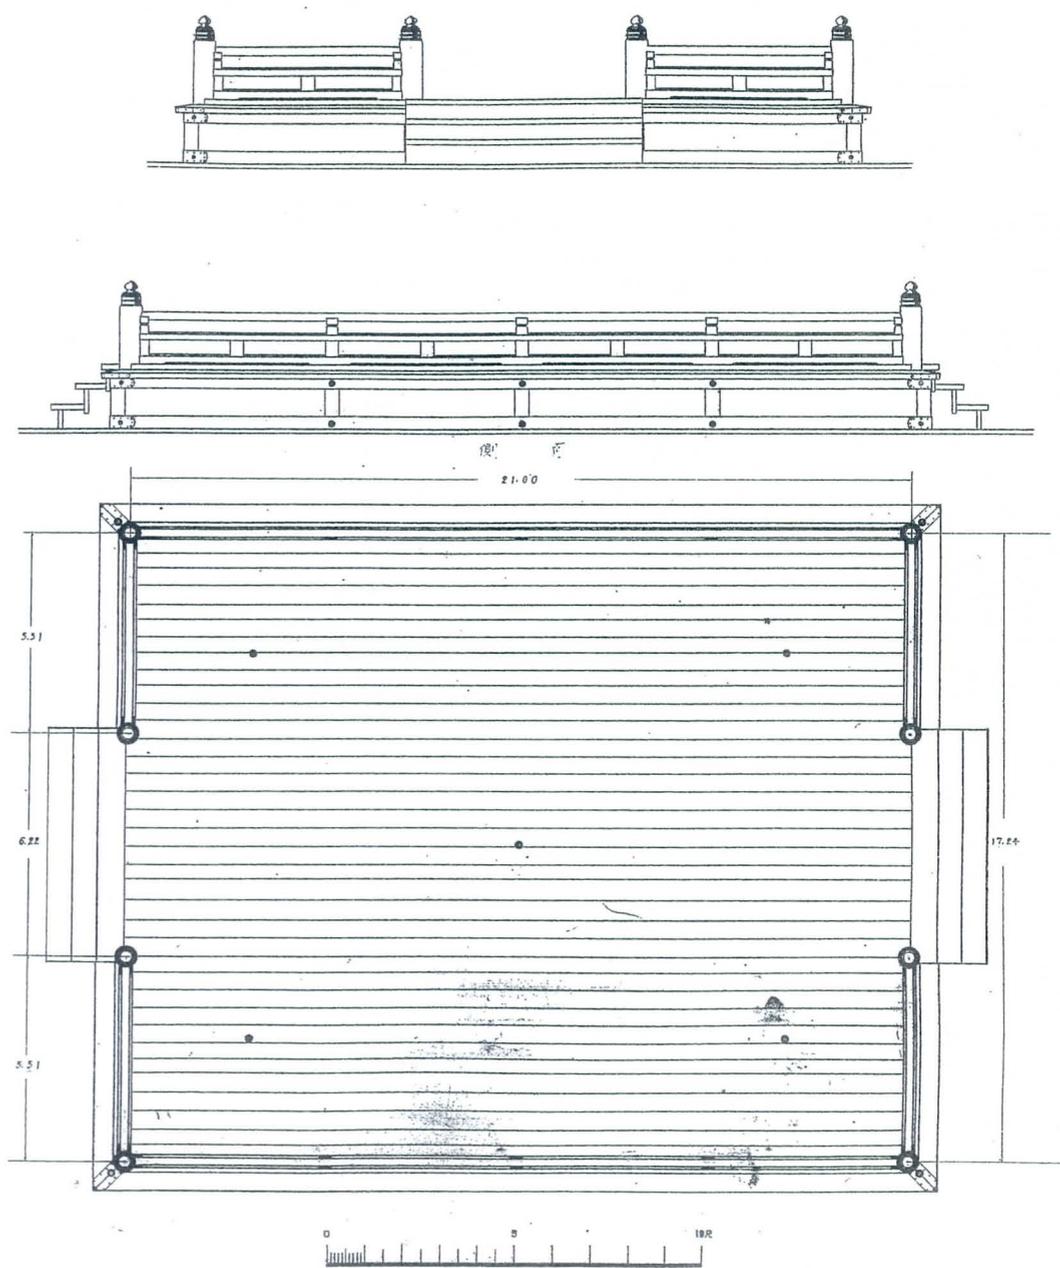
高舞台 平面·侧面图 (文化庁蔵)
